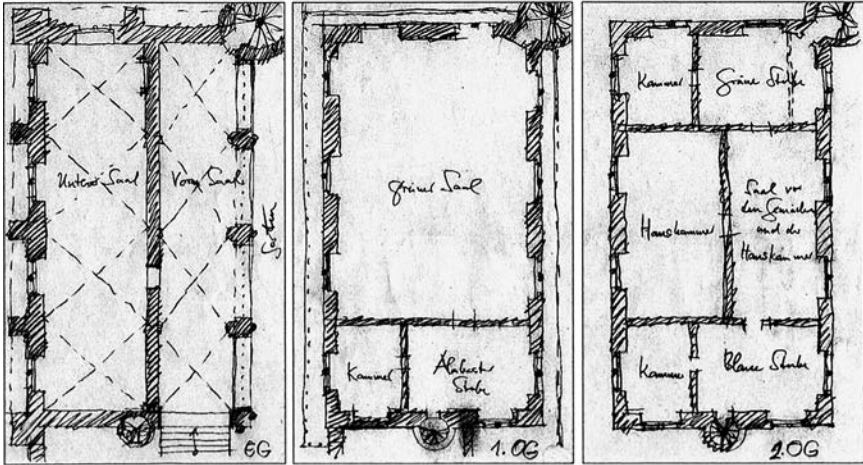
Rekonstruktion der Geschossgrundrisse des Grünen Schlosses, Jürgen Beyer, 2007
